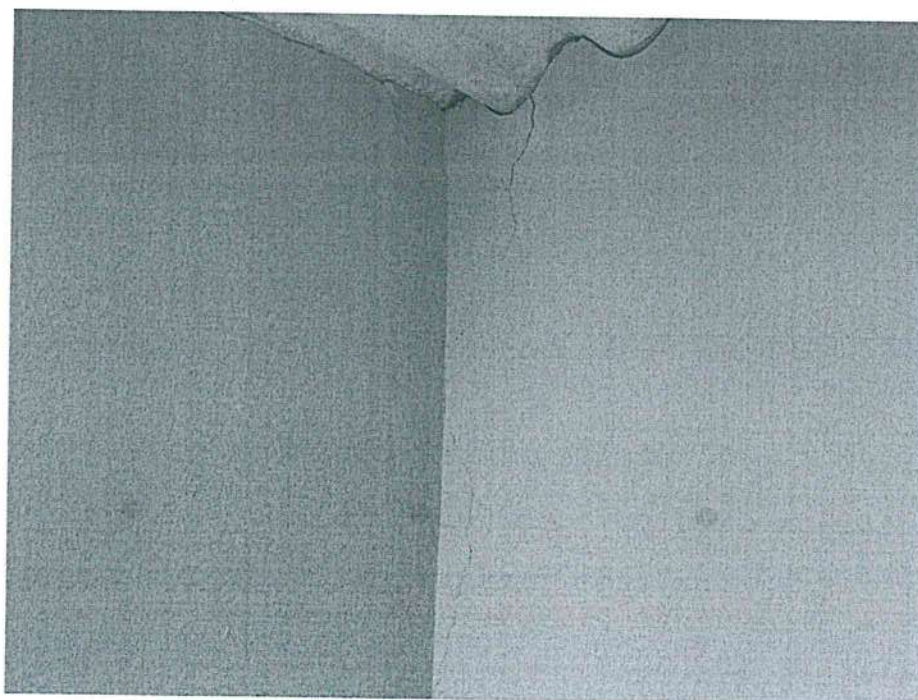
A pesar del tarrajeo y pintado en muro se verifica grietas longitudinales desde cobertura hasta nivel zócalo.
